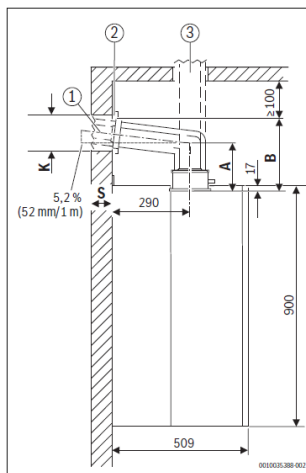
Čelní pohled, vertikální přípojka (mm)
